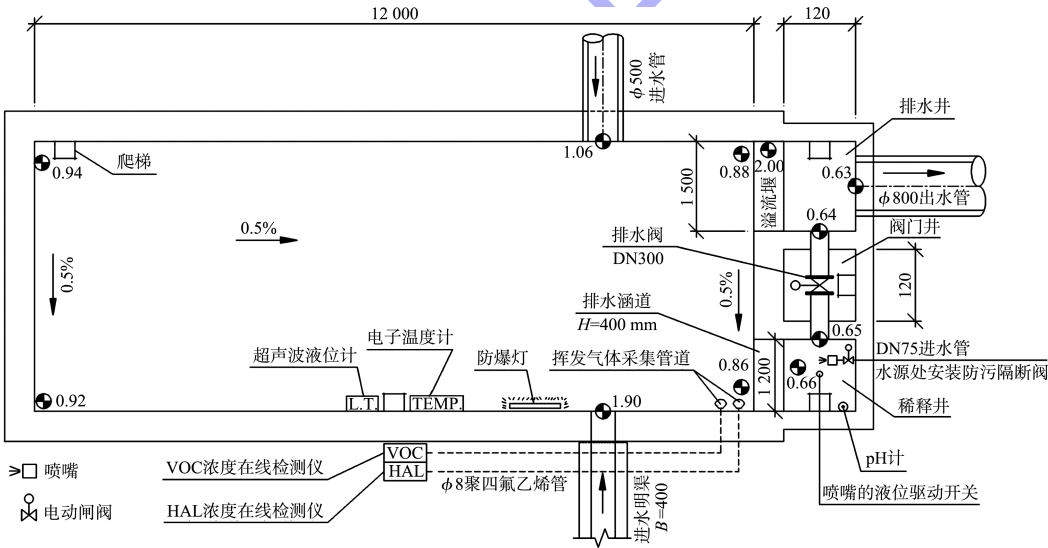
污水池工艺平面布置 (高程: m; 尺寸: mm)
